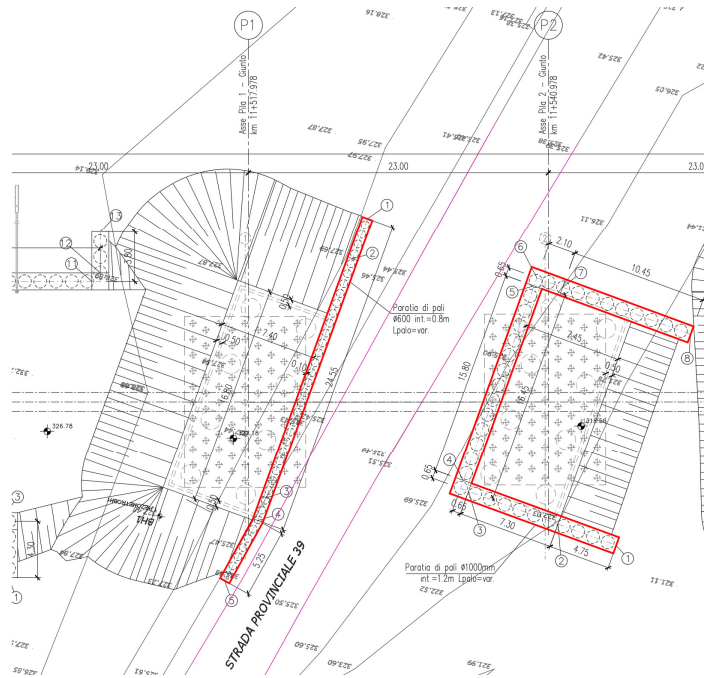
Vista planimetrica scavi Pila 1 e Pila 2
